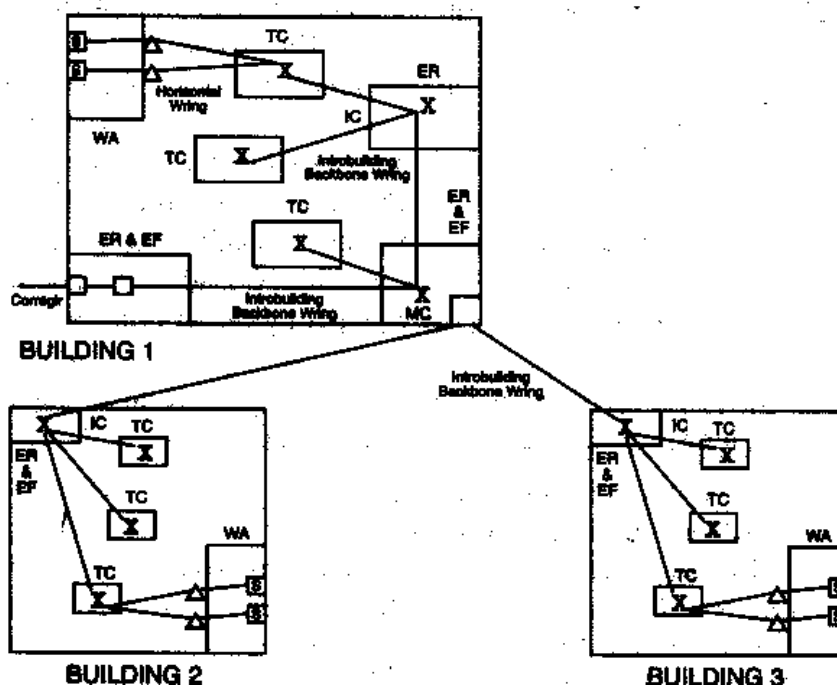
Distribución de facultades de un sistema de cableado estructurado
